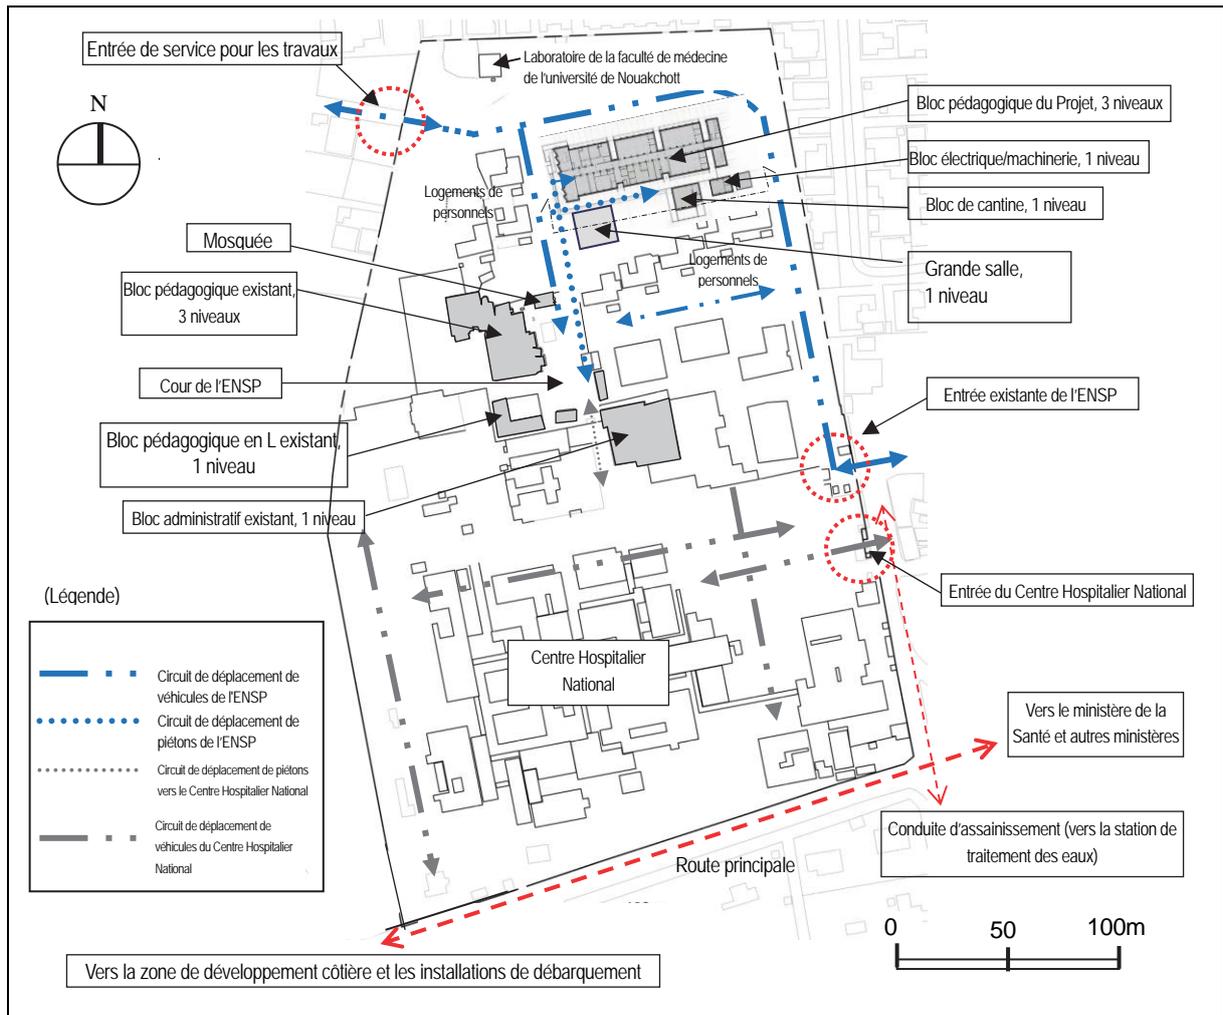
Plan d'implantation des infrastructures et conditions requises pour le plan de circuits de déplacement
